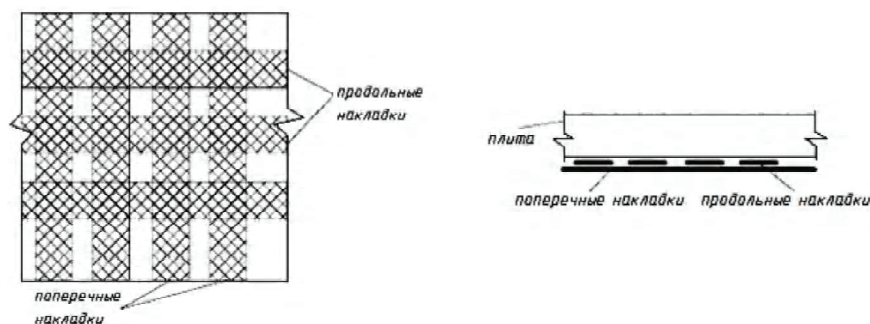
Схема расположения элементов усиления железобетонной плиты перекрытия.
